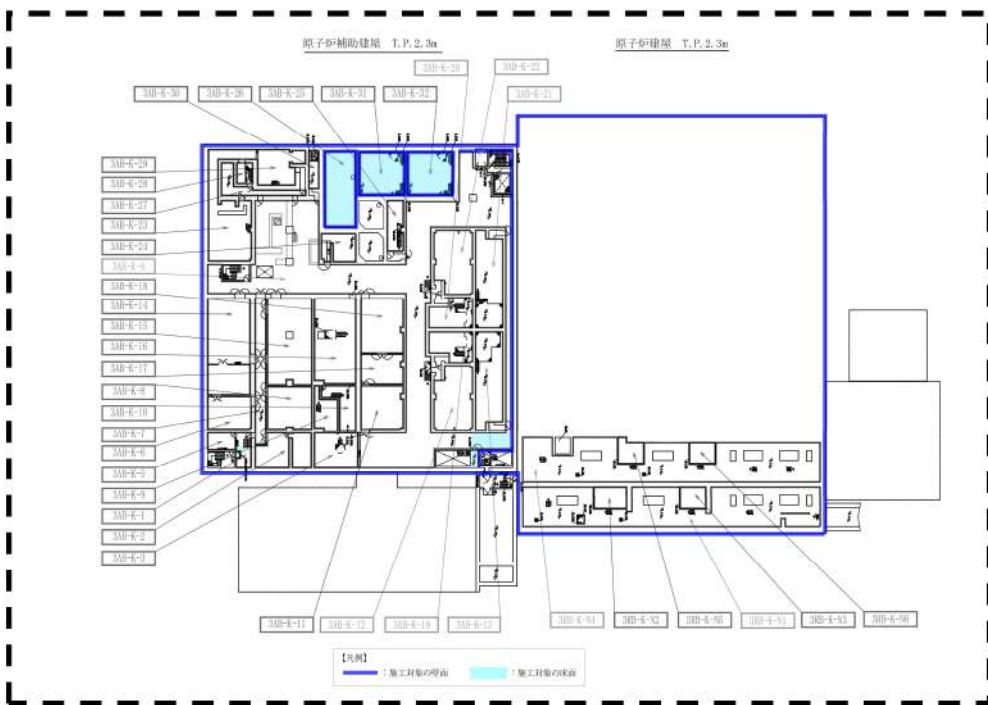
溢水防護対策施工対象の壁及び床の配置図 (9/11)
